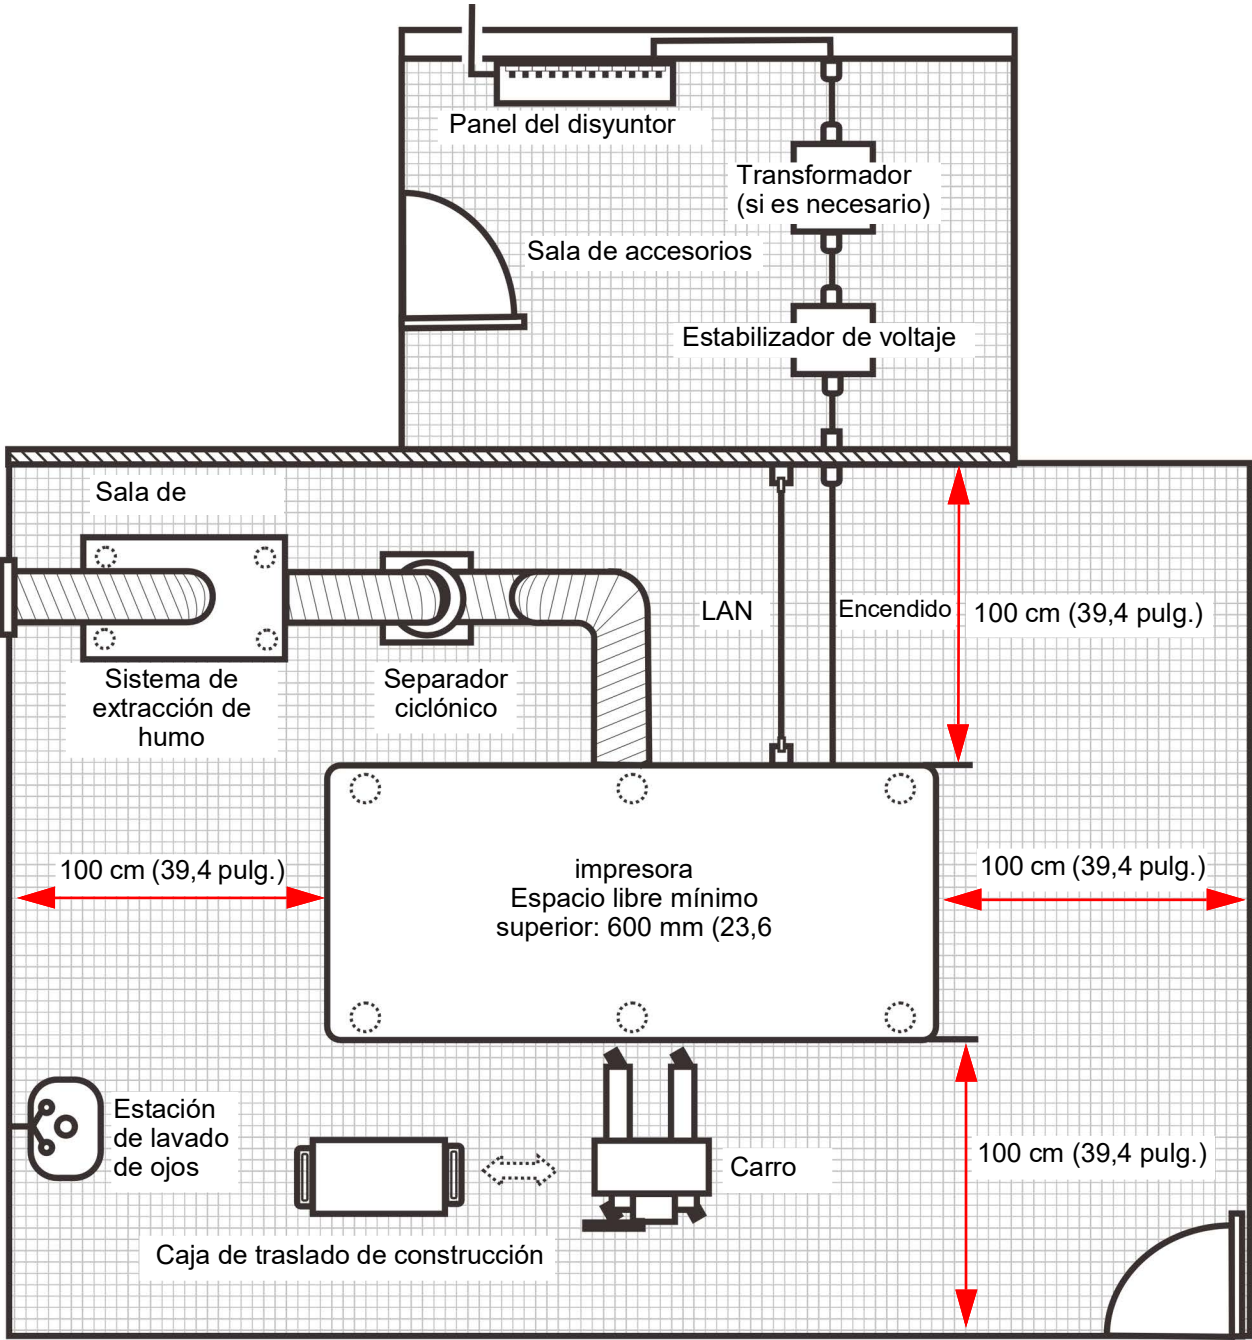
Plano de muestra de la planta de la sala de preparación y posprocesamiento de polvos
